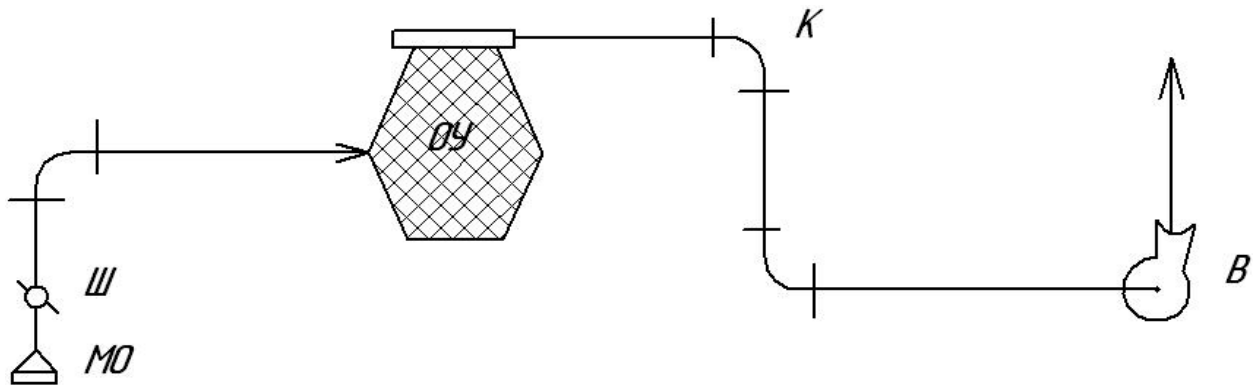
Расчетная схема местной вытяжной вентиляции: МО – местный отсос; ОУ – очистное устройство; Ш – шибер; К – колено; В – вентилятор
